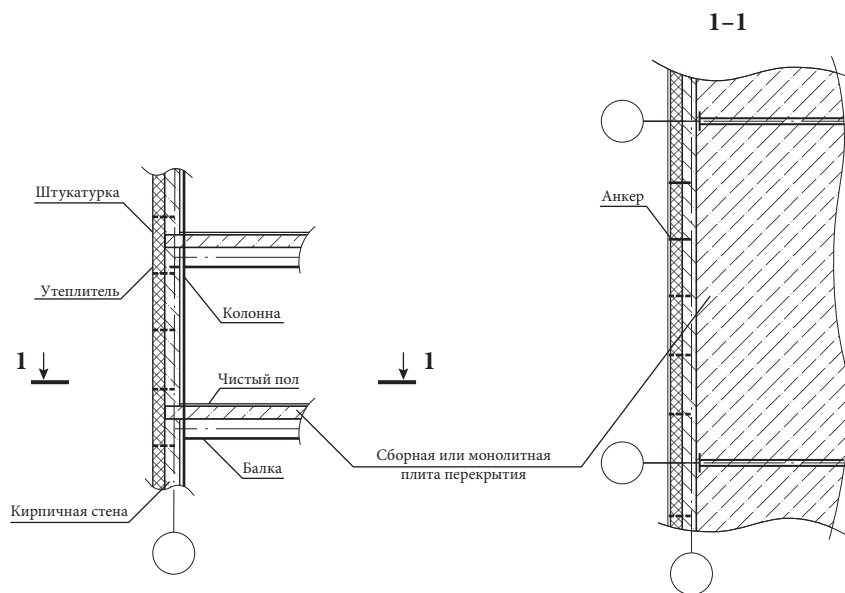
Наружная стена с опиранием кирпичной части на железобетонную плиту перекрытия
